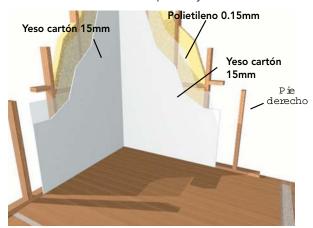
27: Fijación de la barrera de vapor en un tabique perimetral.
